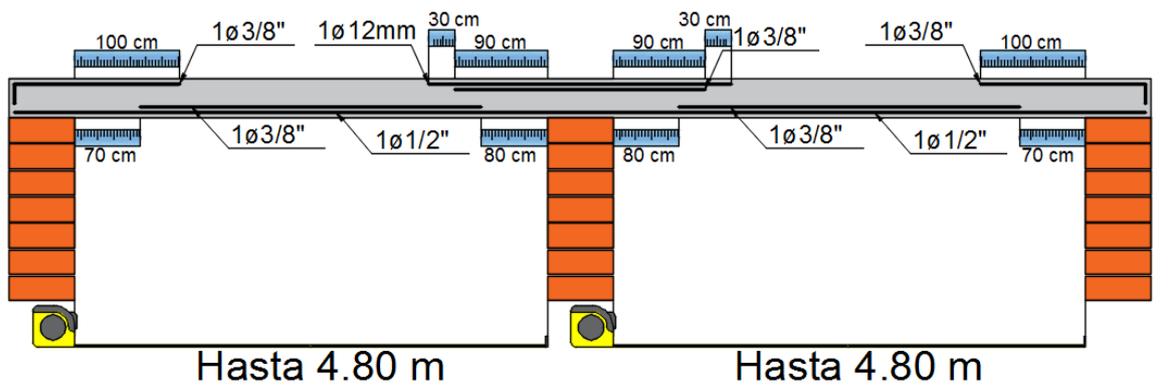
Refuerzo de vigueta hasta 4.80 m por tramo.
